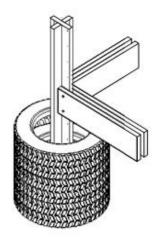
Diseño de Cimentación. FUENTE: Autoría propia.
